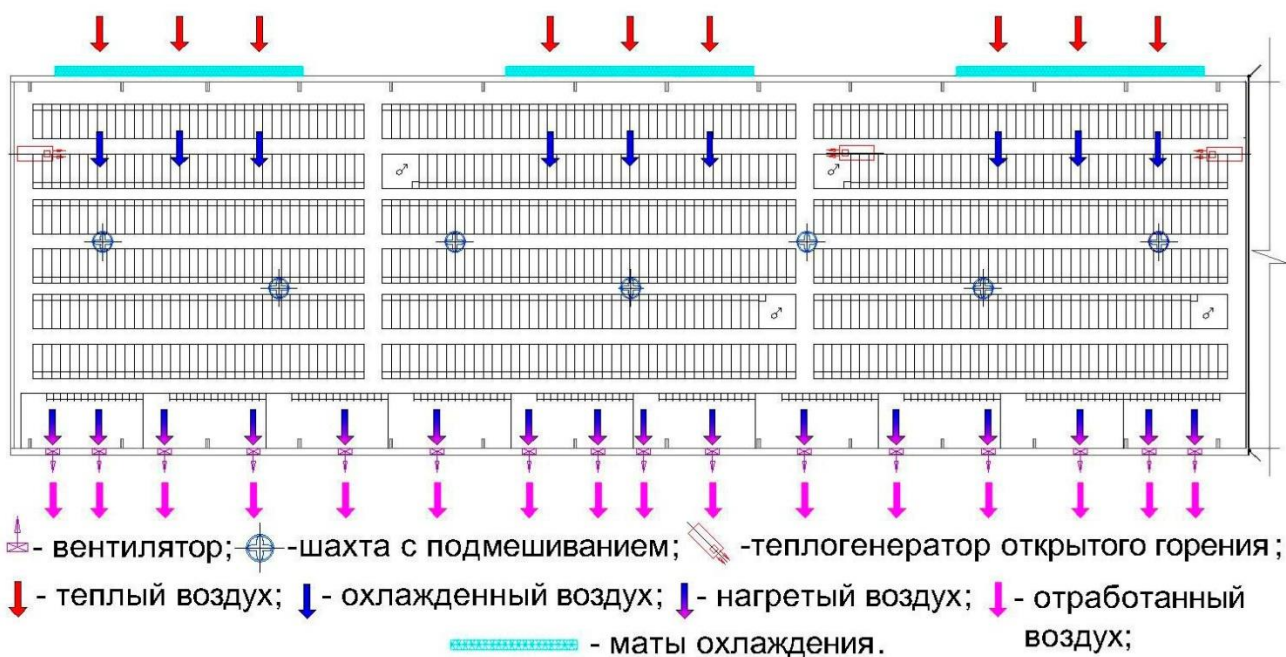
Оптимальная схема вентиляции помещения с потоками воздуха
